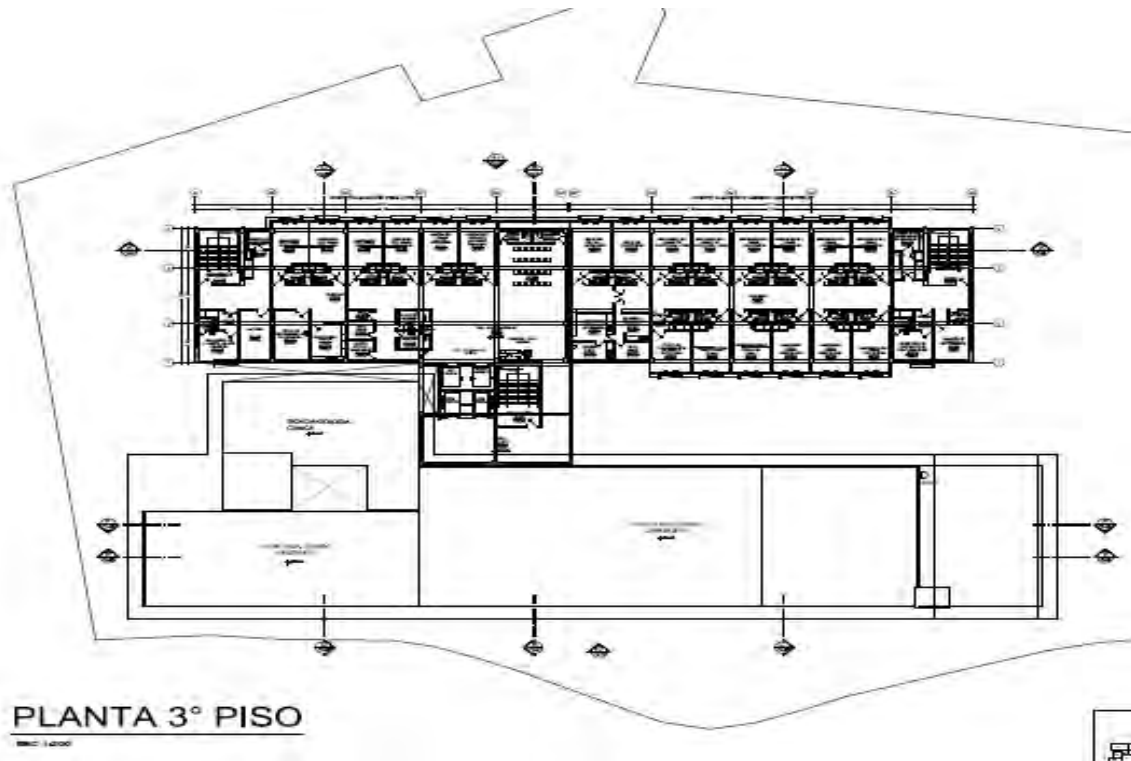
Planta de 3 y 4 piso Hospital Santa María Cutervo
